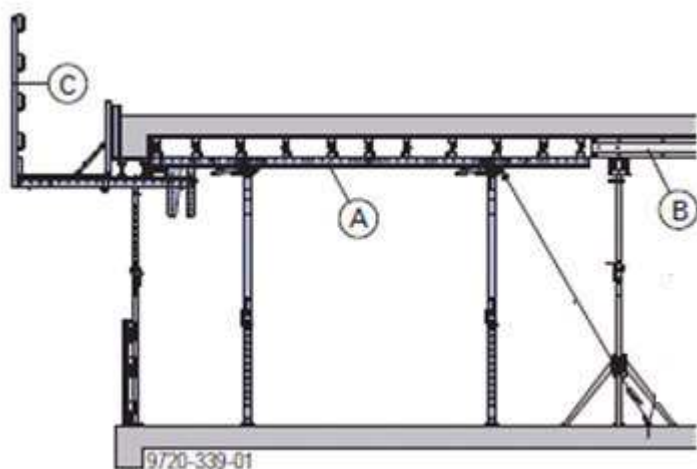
Схема устройства опалубки ж/б балок на краю перекрытия
